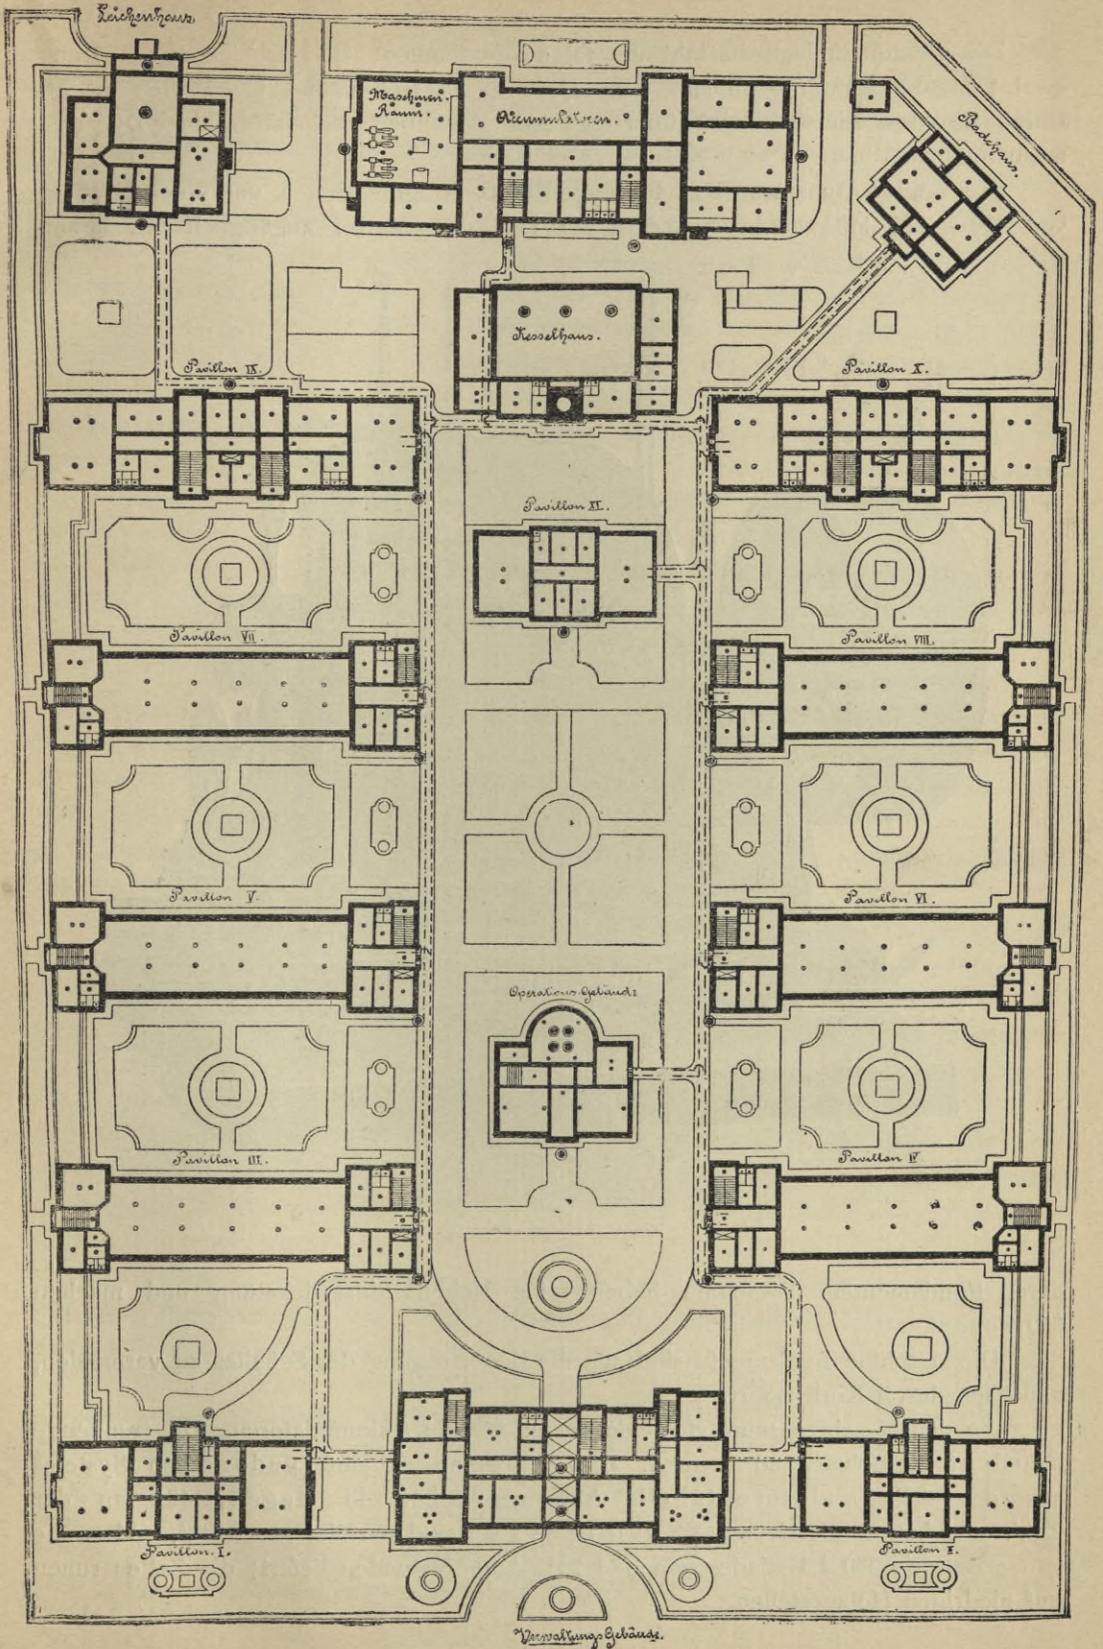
Lageplan des städtischen Krankenhauses Am Urban in Berlin.
